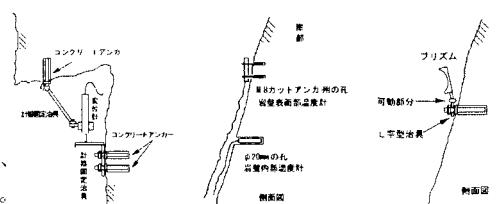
変位計設置状況 図-4 温度計設置状況 図-5 プリズム設置状況
